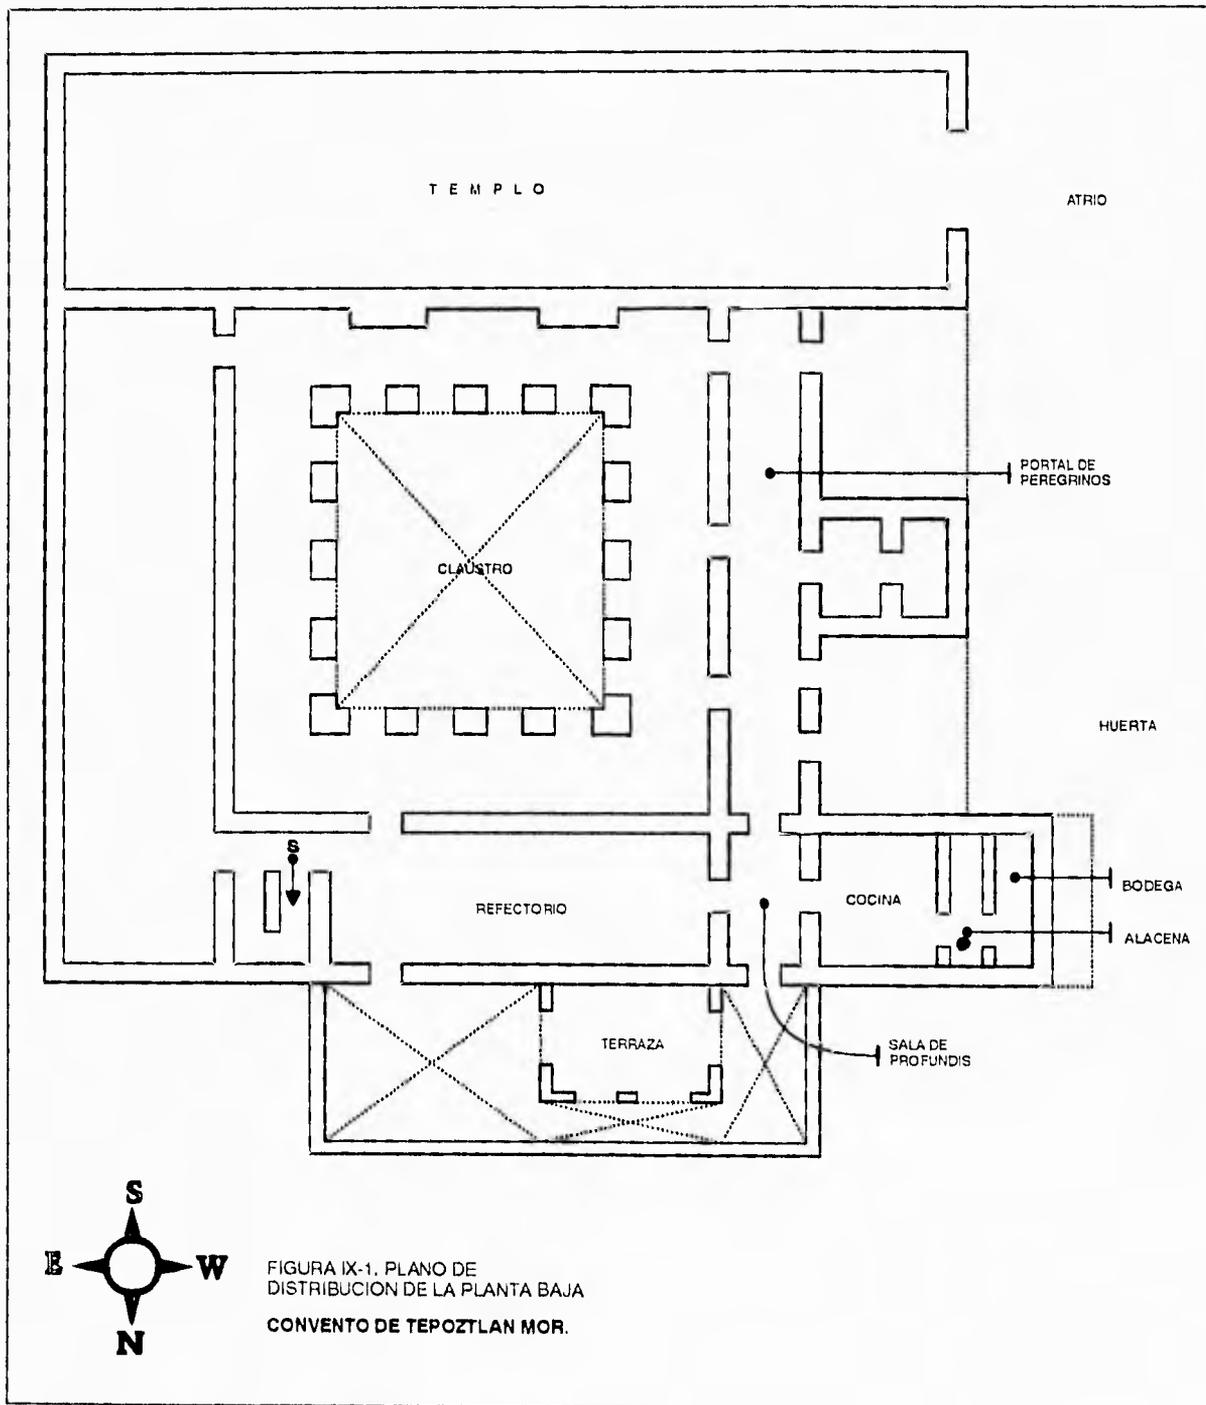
Plano de distribución de la planta baja del convento de Tepoztlán.
